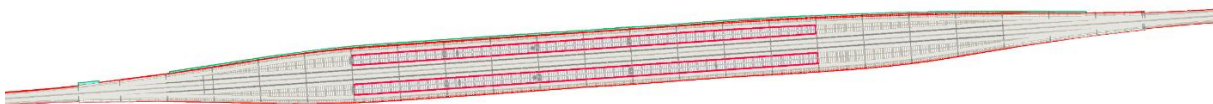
Lageplan Bahnhof Hausruckviertel [eigene Darstellung]
